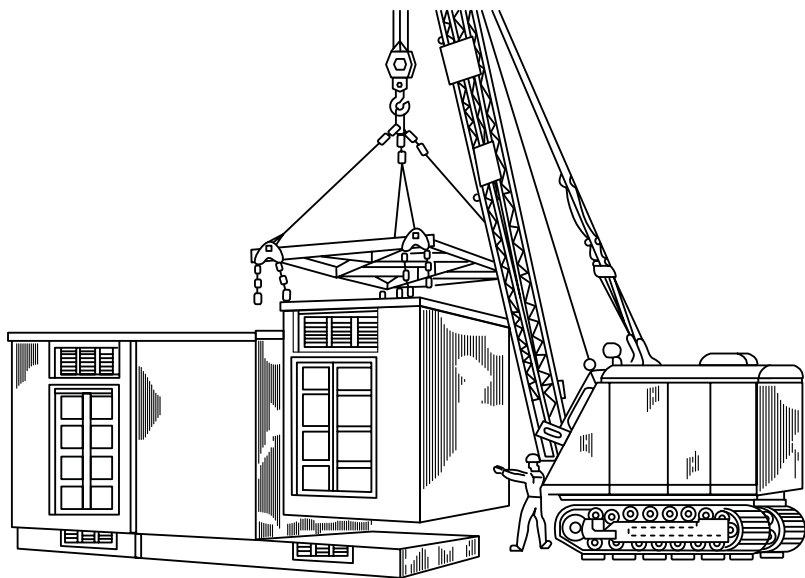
Монтаж трансформаторной подстанции из объемных блоков на строительной площадке
